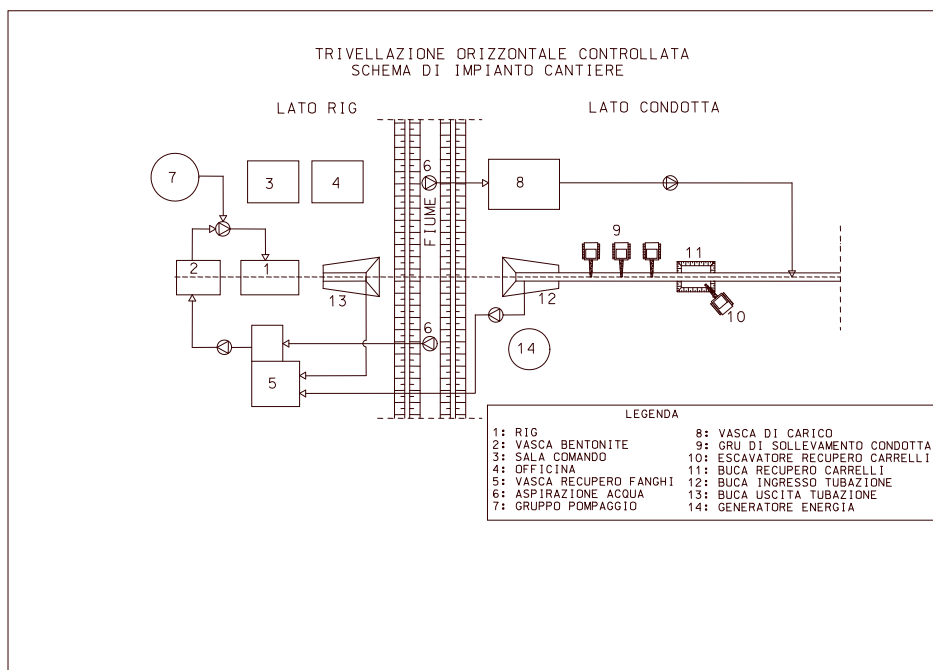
Schema planimetrico del cantiere tipo per la realizzazione di una T.O.C.
